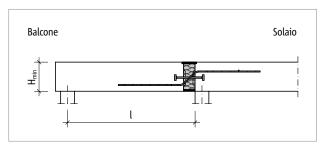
Schöck Isokorb® T tipo QP: sistema statico
